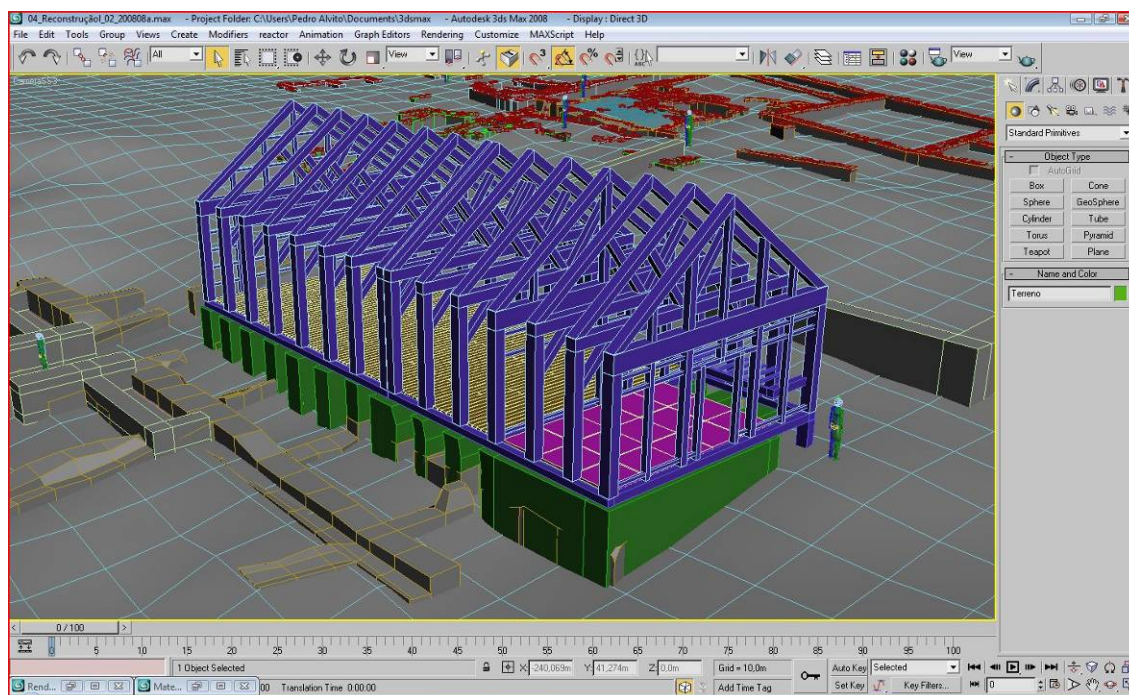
Reconstrução do celeiro, com a estrutura principal em pórticos.
